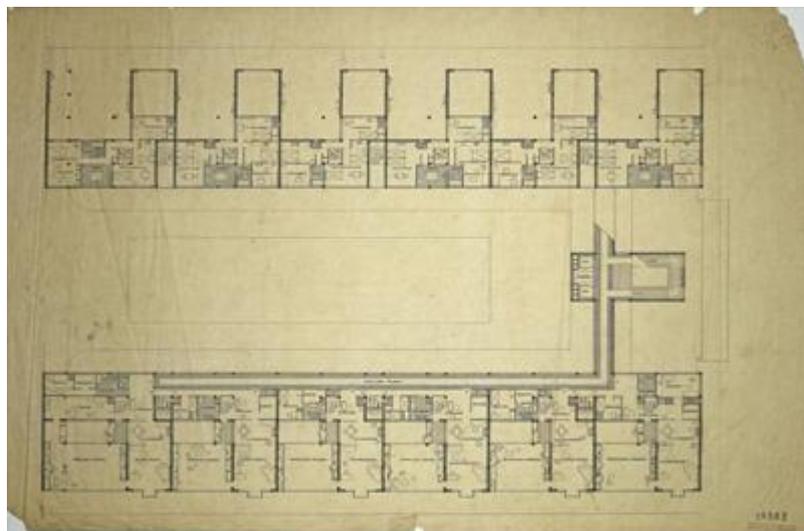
Planta da ligação das células às galerias de acesso do complexo das Immeubles-Villas
